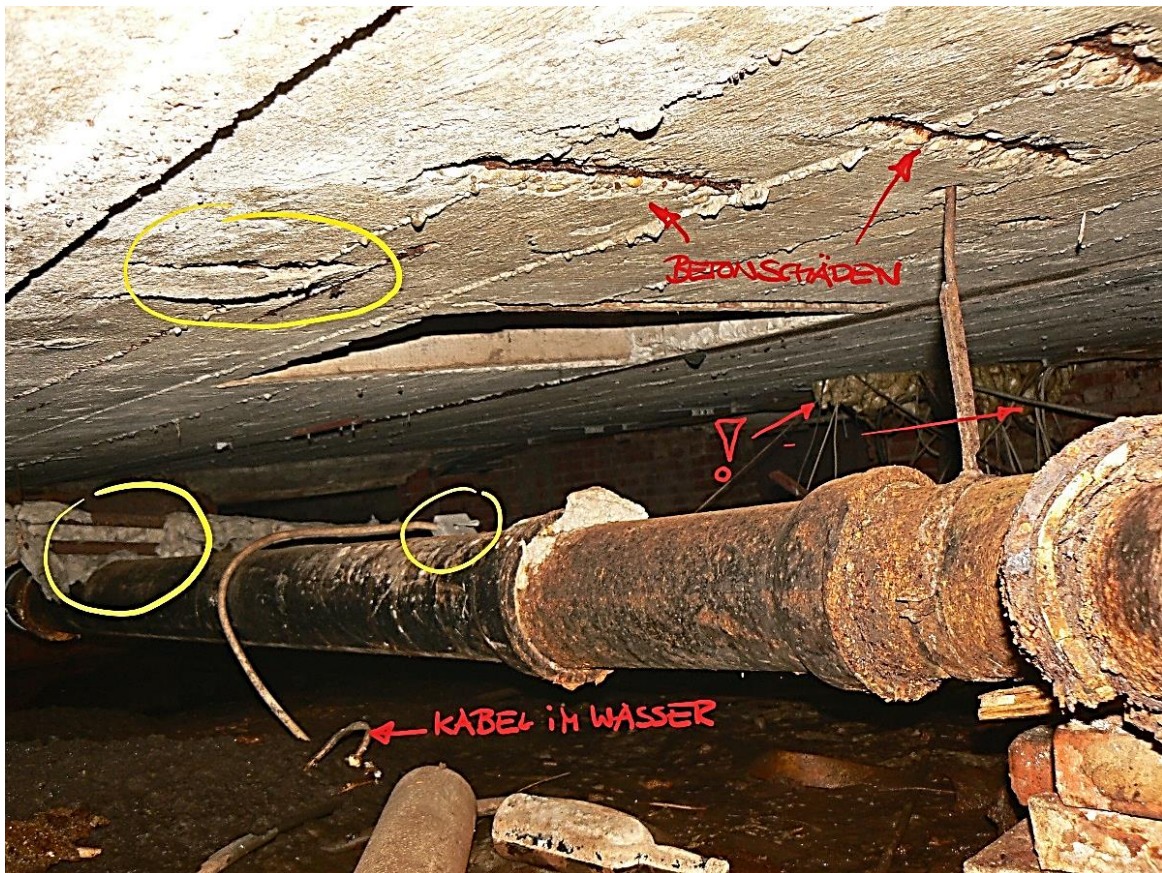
Foto Kriechkeller, Datum: 04.03.2021
